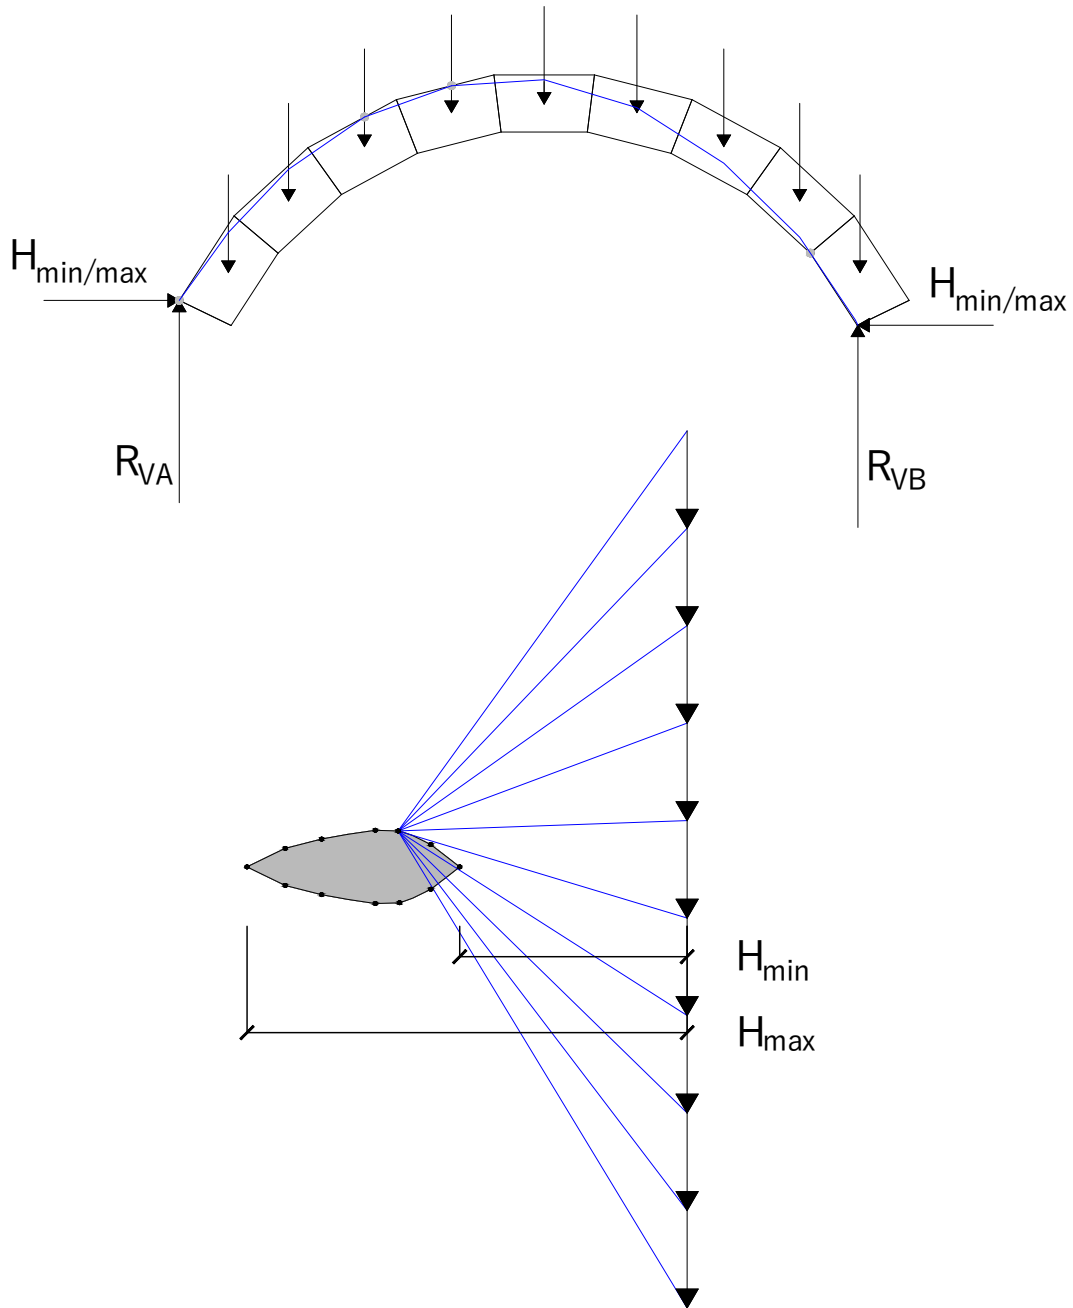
Plan de situation (dessus) et plan des forces (dessous) dans l'interface Rhinocéros
